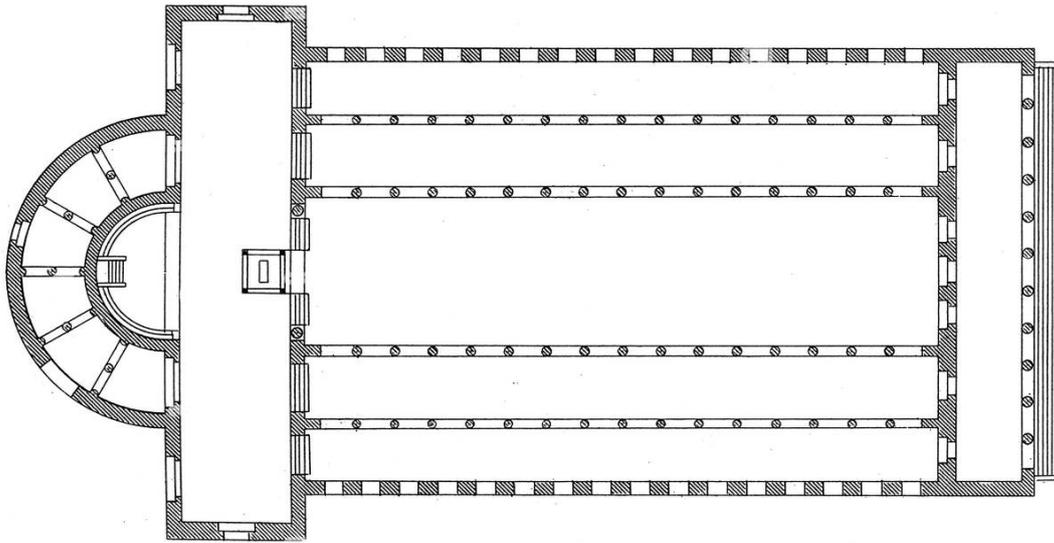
Grundriss Lateranbasilika in Rom³⁵
